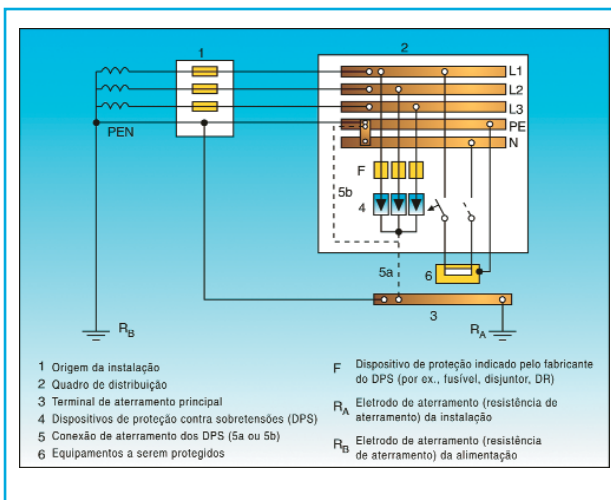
Instalação dos dispositivos de proteção contra sobretensões (DPS) em esquemas TN
